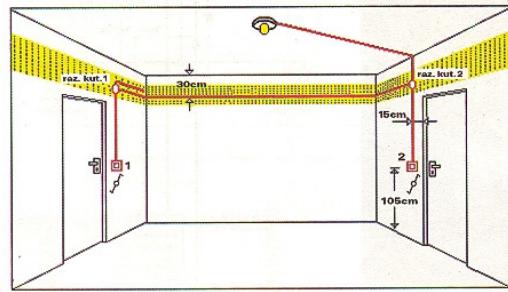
Plan instalacije rasvete u sobi s dve naizmenične sklopke
